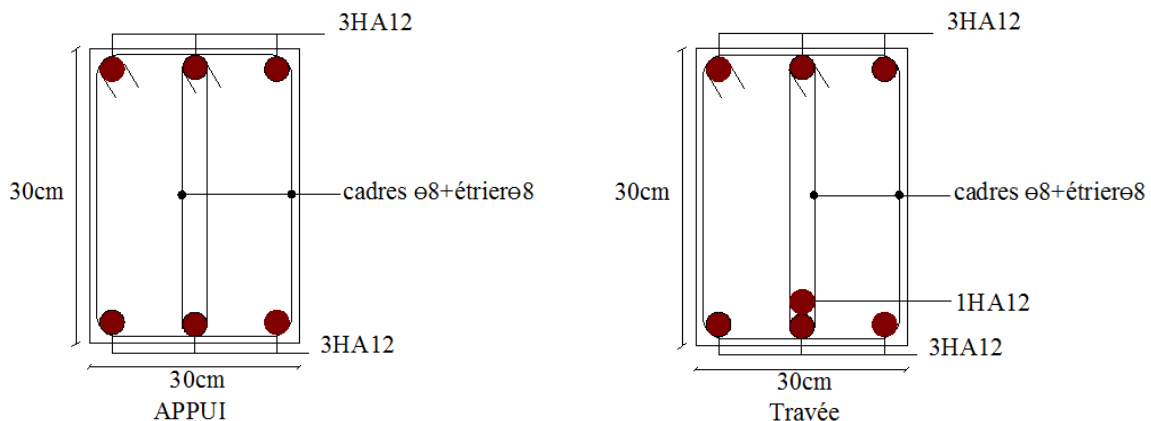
Schéma de ferrailage de la poutre de chaînage.
